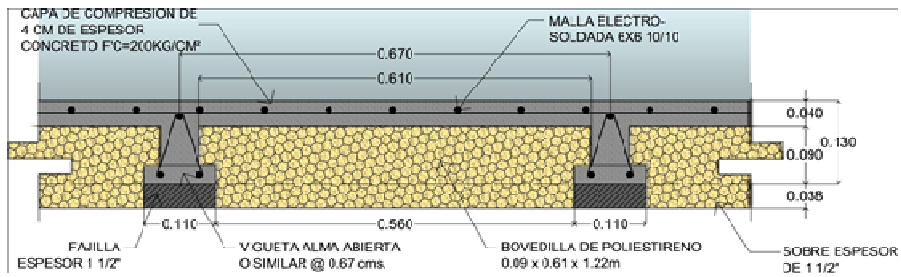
Sistema constructivo vigueta y bovedilla utilizado en Cubierta
